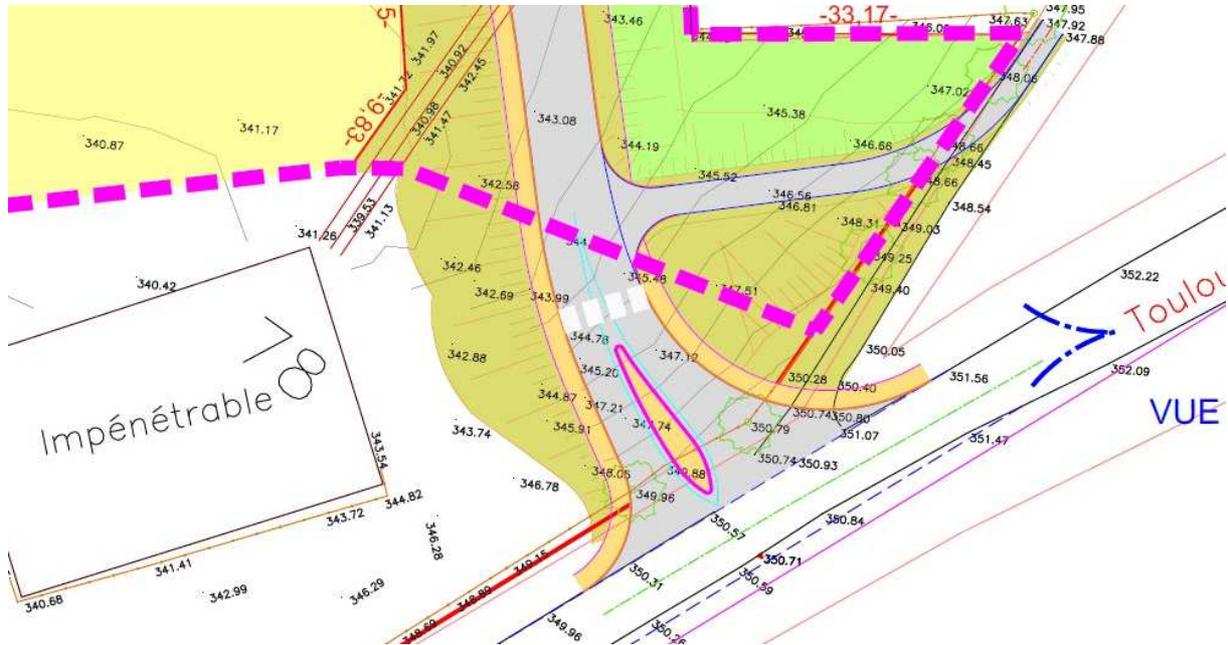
Zoom sur le raccordement de la voie de desserte à la RD920 (extrait du plan de composition d'ensemble de GETUDE, hors échelle)
